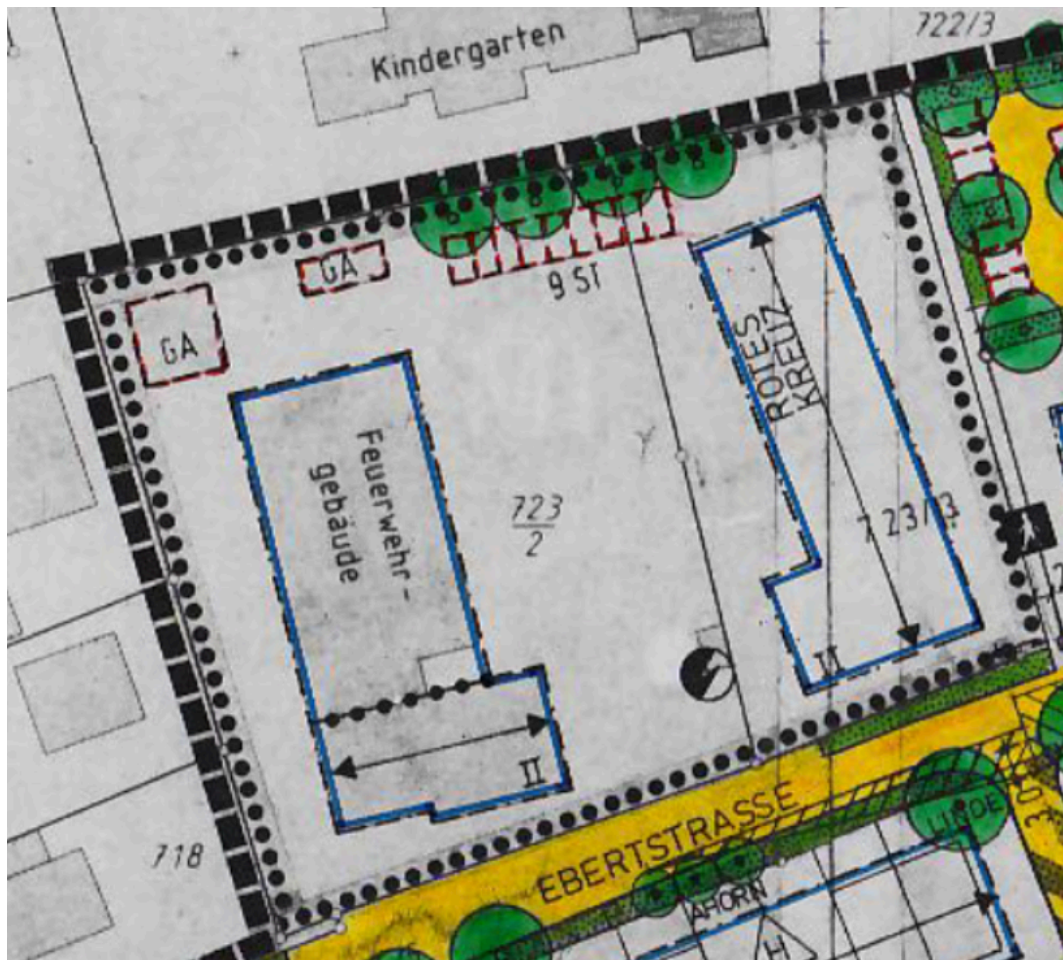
Markt Peißenberg Ausschnitt B-Plan „An der Ludwigstraße II“
